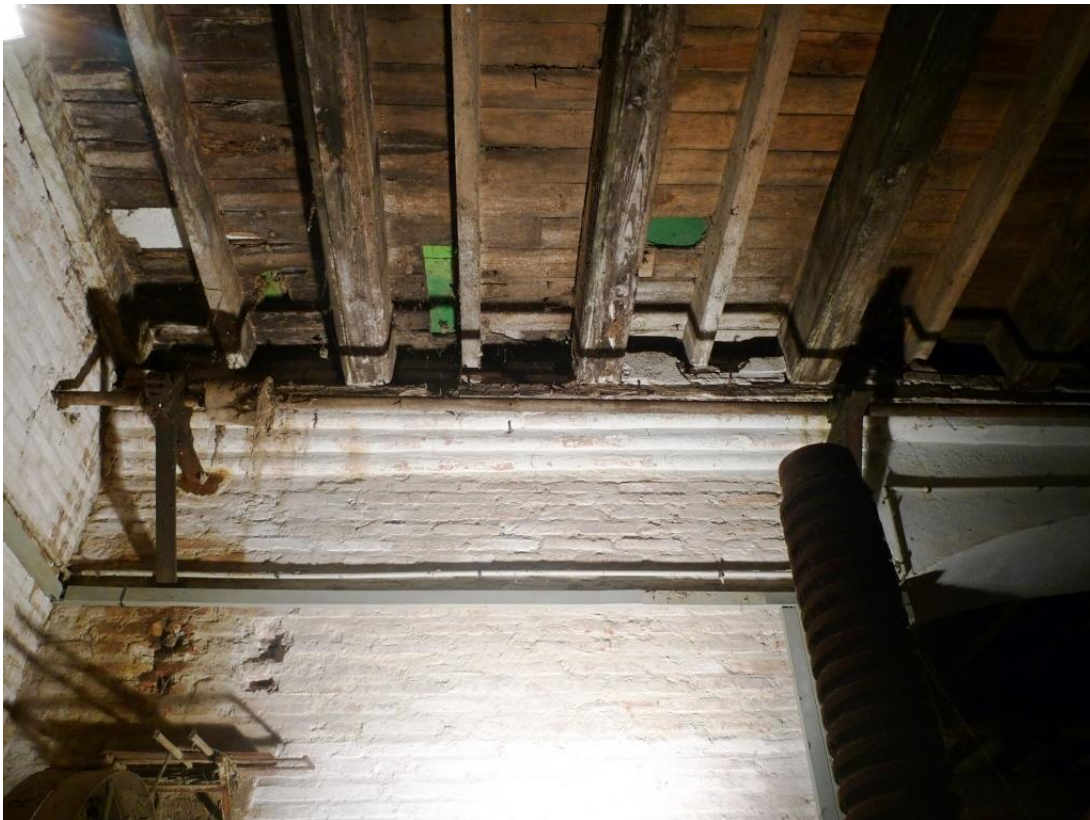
Poutres moulurées dans les angles, plafond de la pièce au rez-de-chaussée du corps A2.
